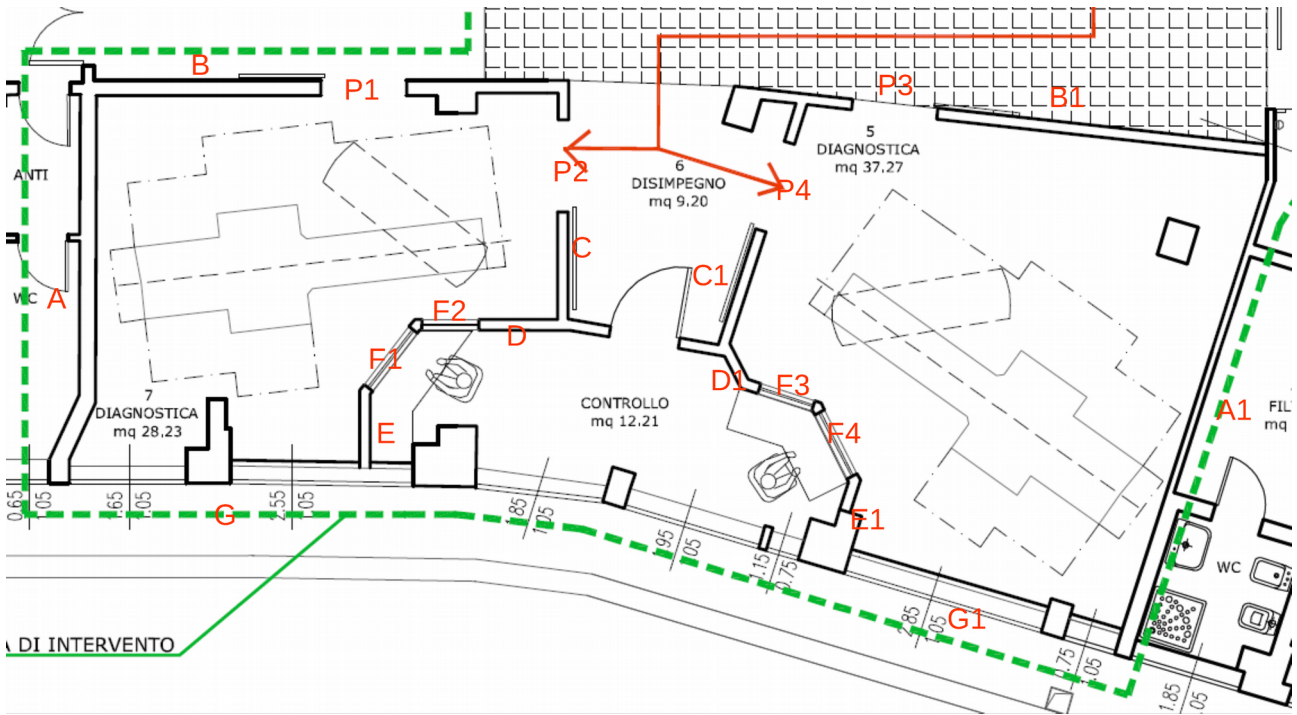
Planimetria sale SPECT-TC e punti per calcolo barriere
